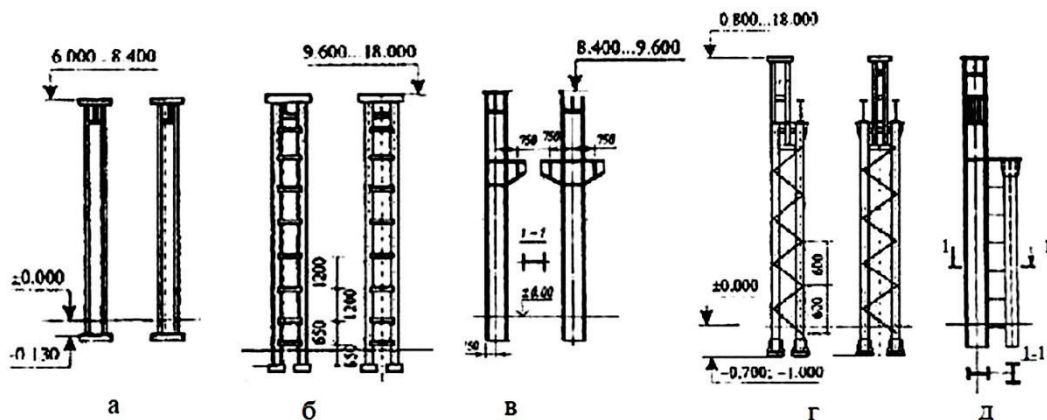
Типы колонн одноэтажных промышленных зданий:
